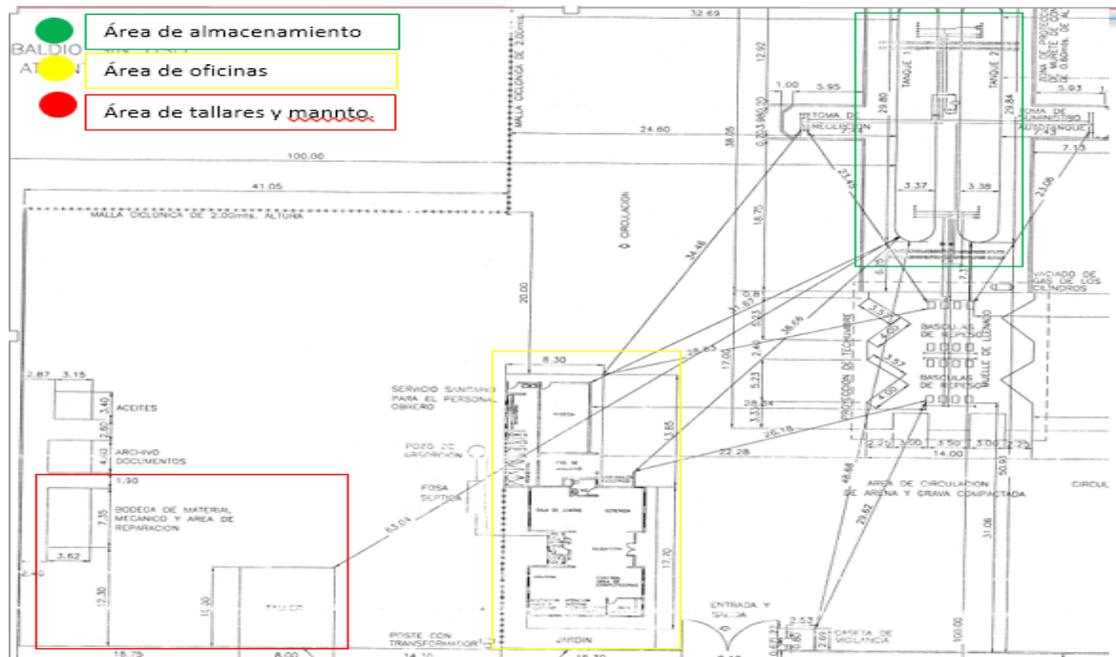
Layout de la planta de almacenamiento y distribución. Adaptado del plano del proyecto civil.
